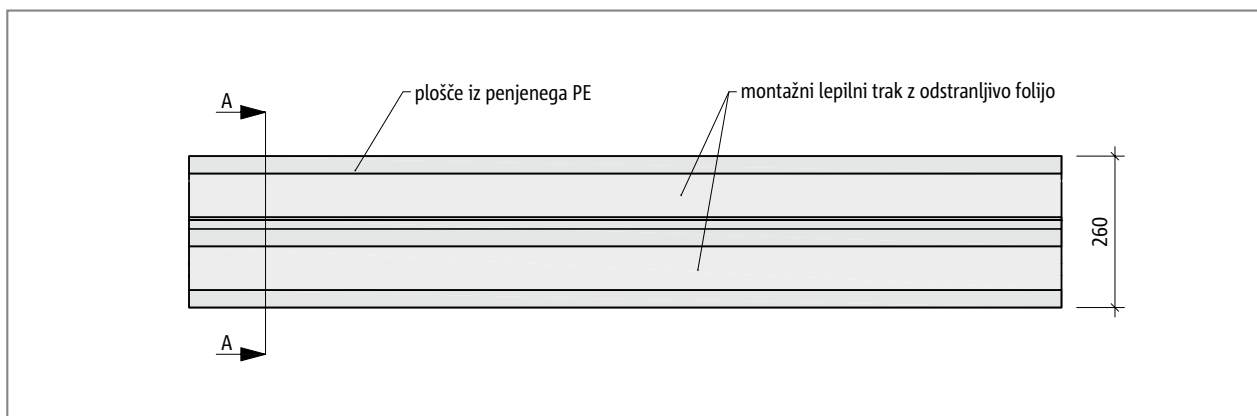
Schöck Tronsole® tip F: razvrstitev elementov, detajl B
